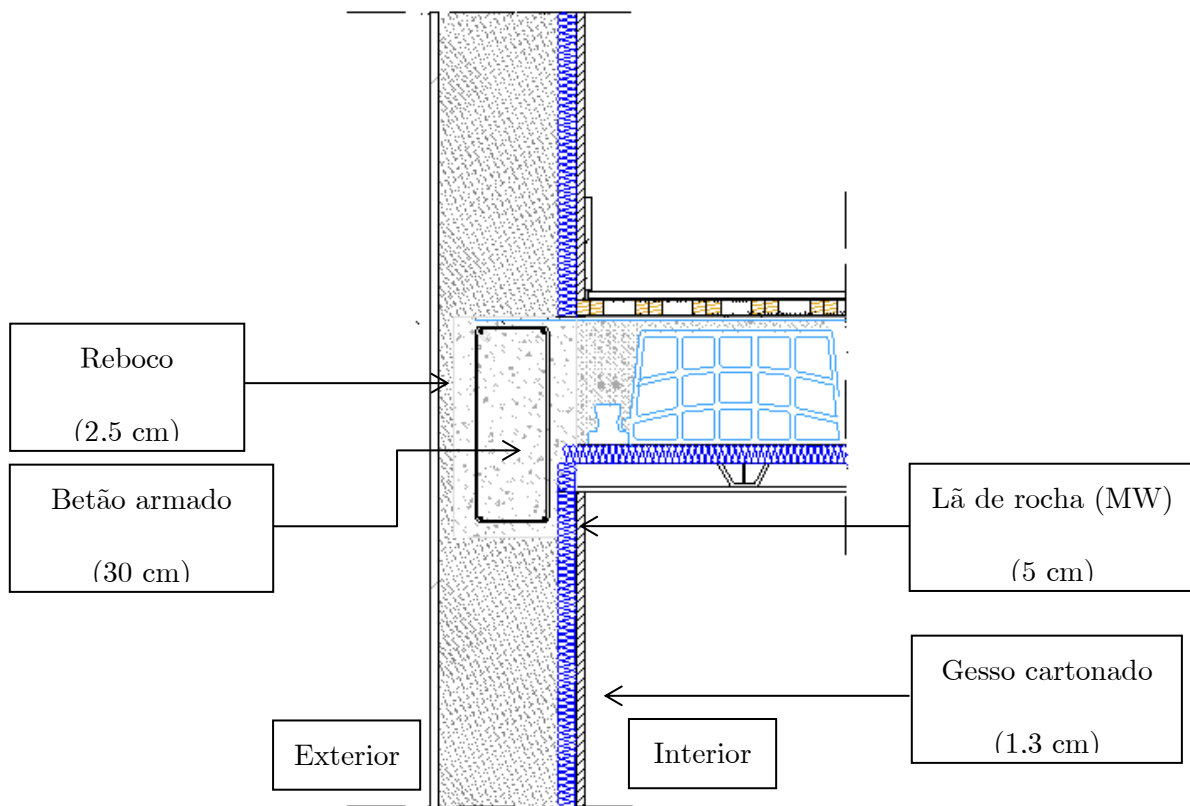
Pormenor construtivo das vigas ( $N_1$ )
